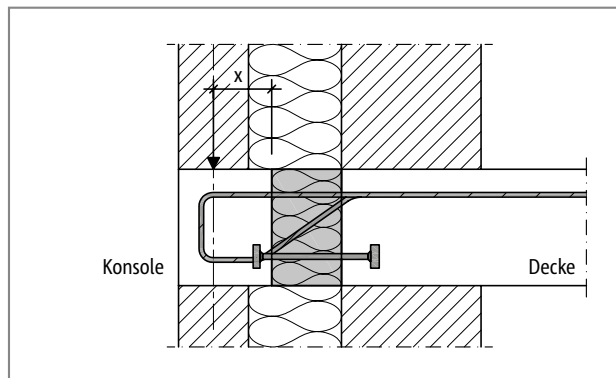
Schöck Isokorb® XT Typ O: Konsole mit Verblendmauerwerk
